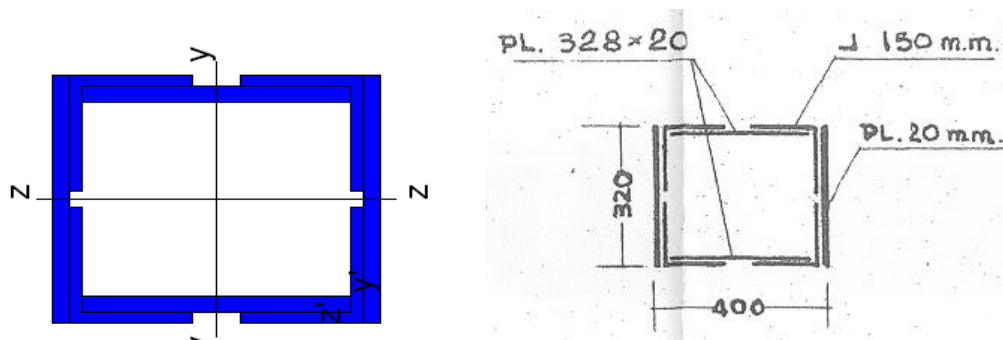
Pilar planta 3a, 4a, 5a i 6a. [1]
